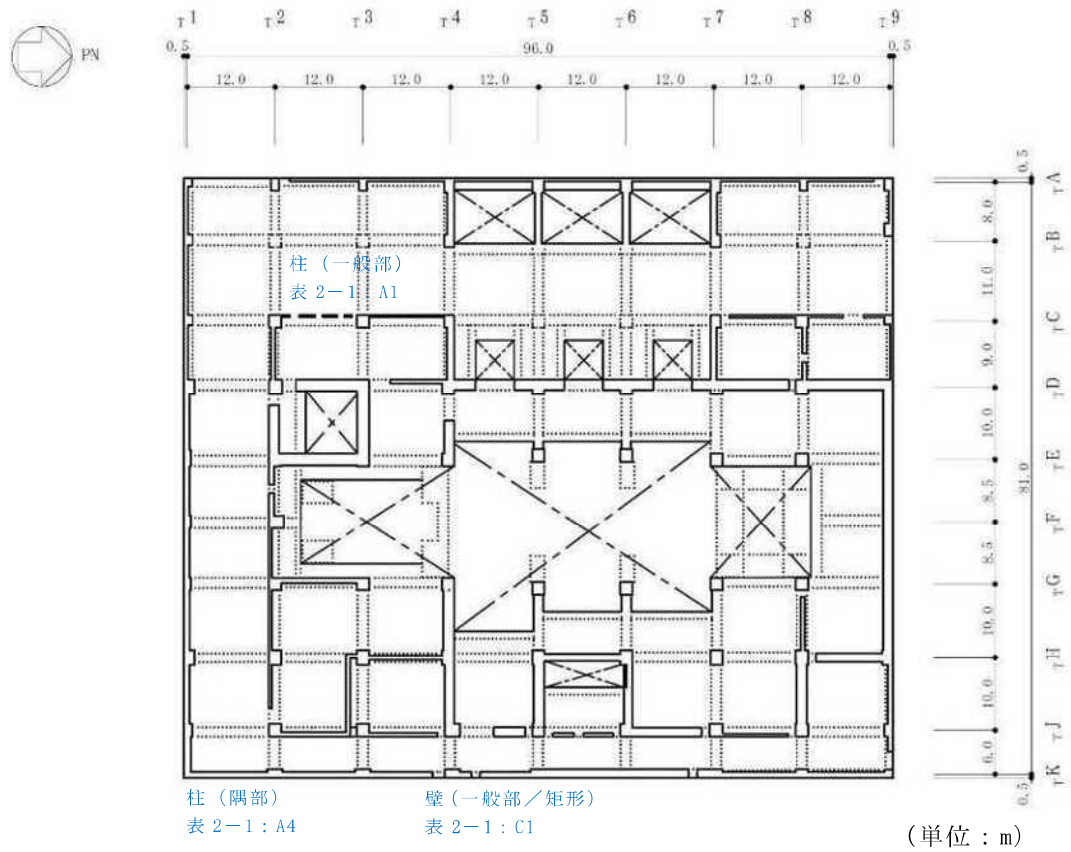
タービン建屋の概略平面図 (1F, T.M.S.L. 12.3m) (3/5)
